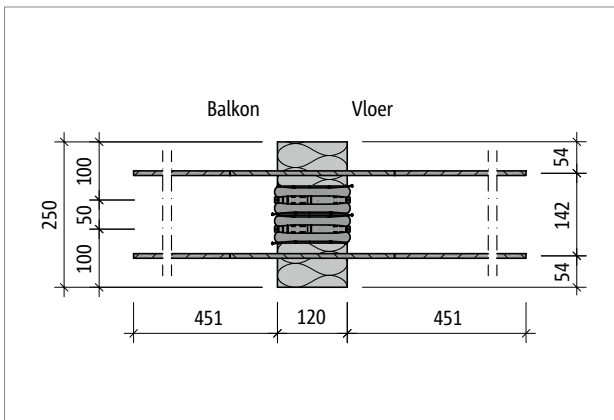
Schöck Isokorf® XT type Q-E-V4 bij: Doorsnede
